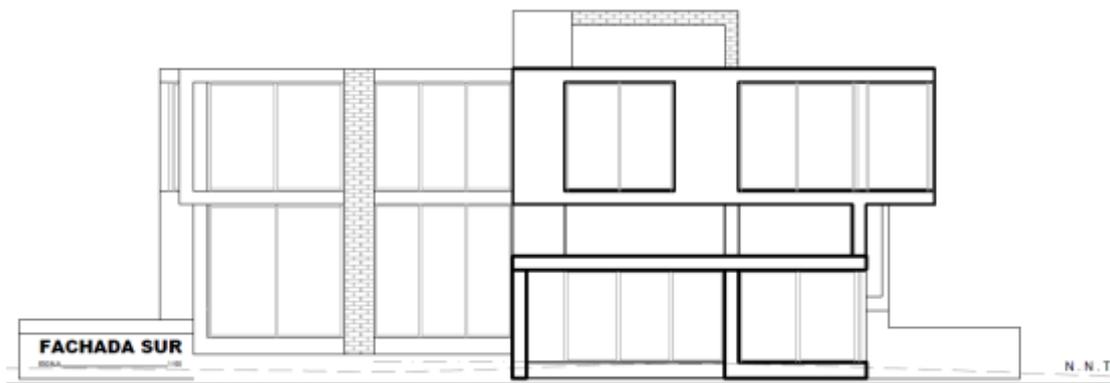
Fachada Sur casas 15 A y 15 B, (Casas Adosadas)
